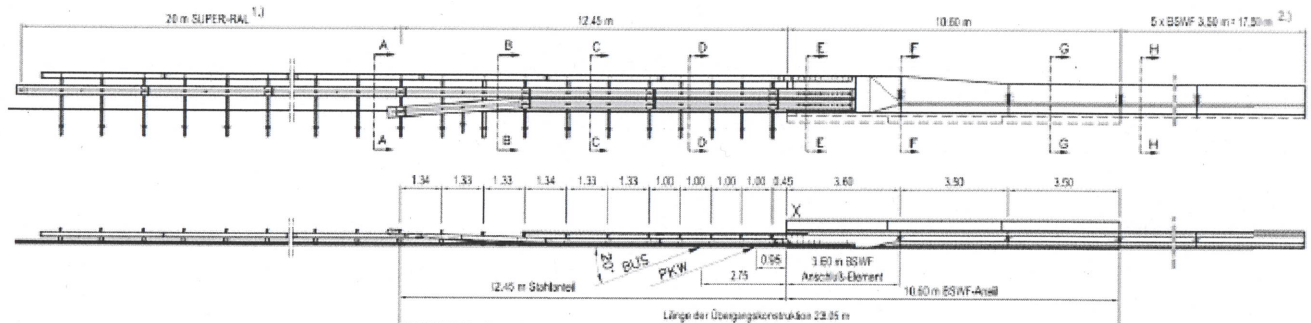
Aufbau der Übergangskonstruktion BeStConnect SR
